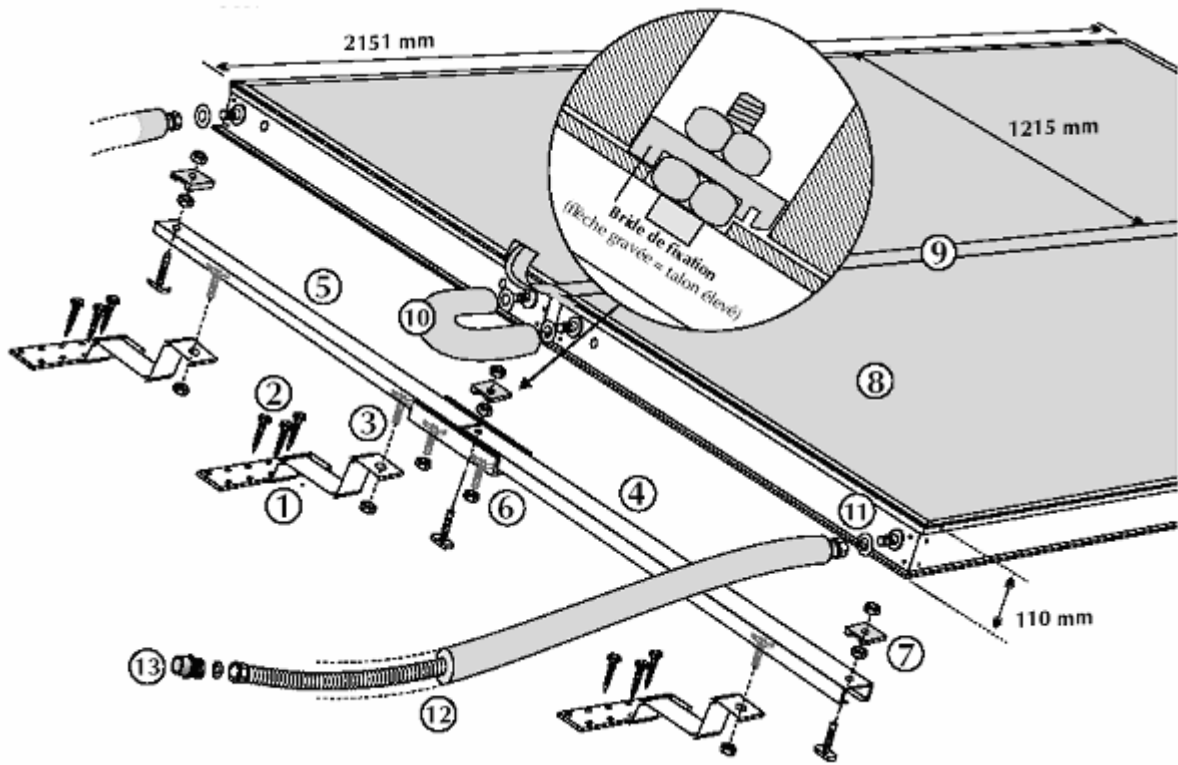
Kit de fixation pour façade, toiture inclinée pattes de fixation option tuiles mécaniques
